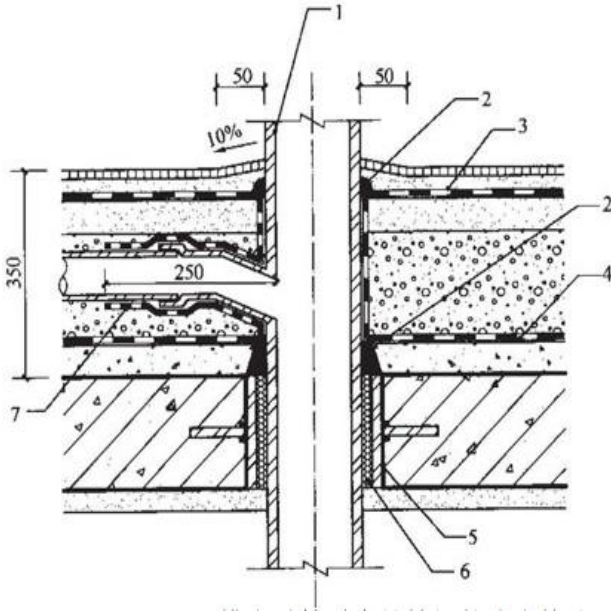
同层排水时管道穿越楼板的防水构造
